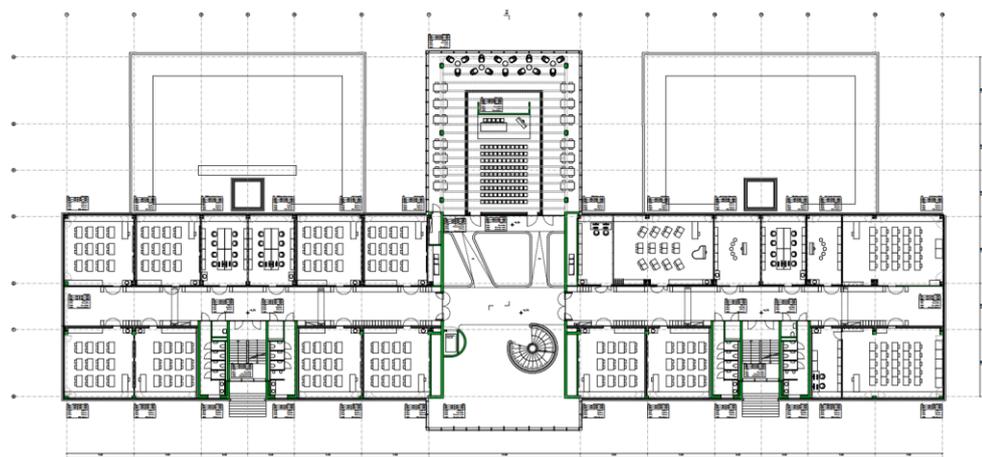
Pianta secondo piano – Durisch + Nolli Architetti sagl
